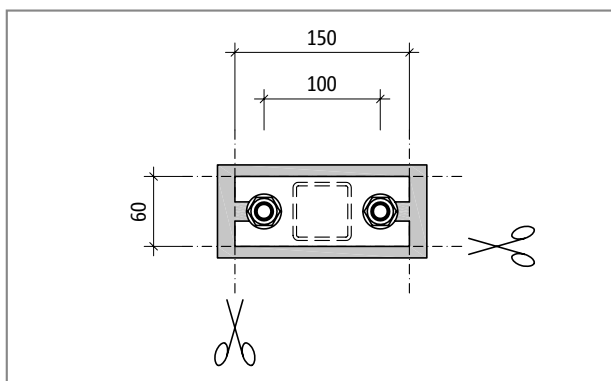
Schöck Isokorb® T tipo S-V: dimensione dopo la separazione del materiale isolante
